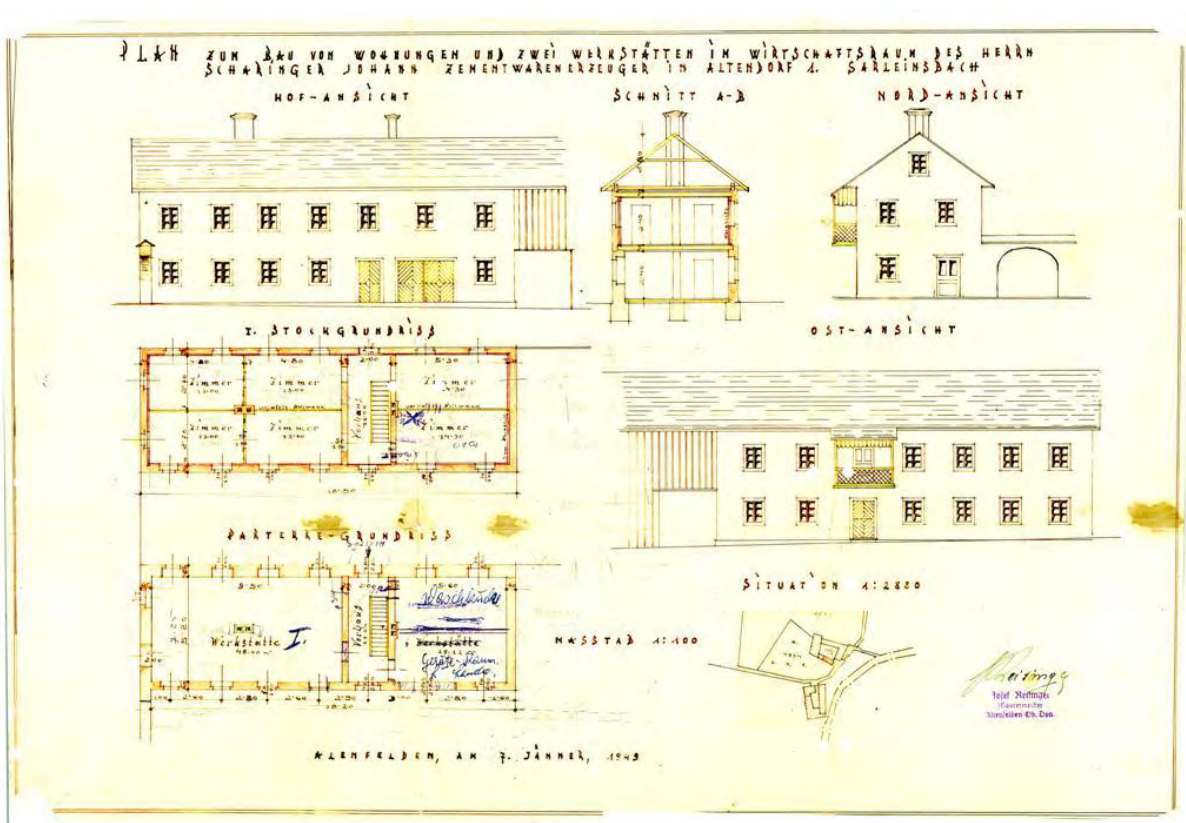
Original Einreichplan der Lehrbaustelle (Format DIN A2)
